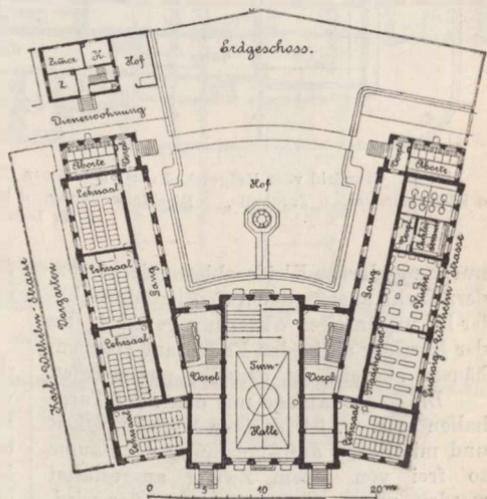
Grundriß vom Erdgeschoß einer Volksschule in Karlsruhe (s. S. 642).
